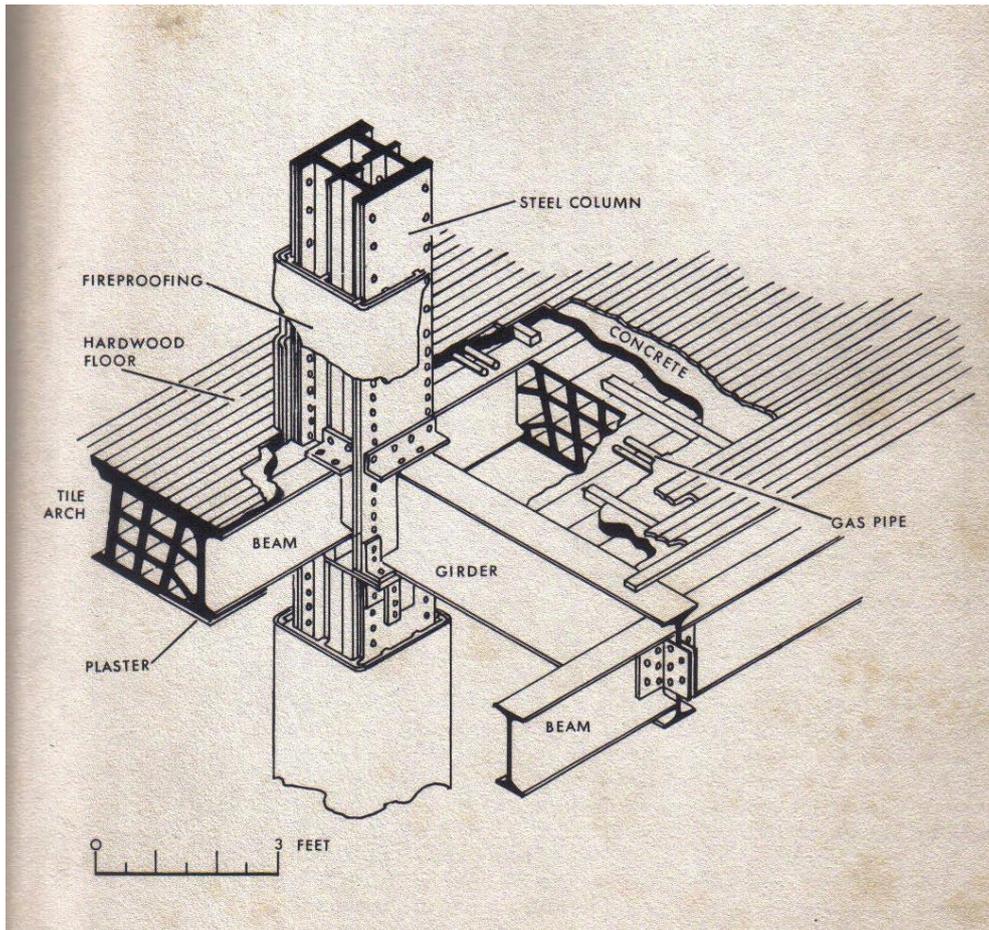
pormenor construtivo edificio Le Baron Jerrey, Chicago
